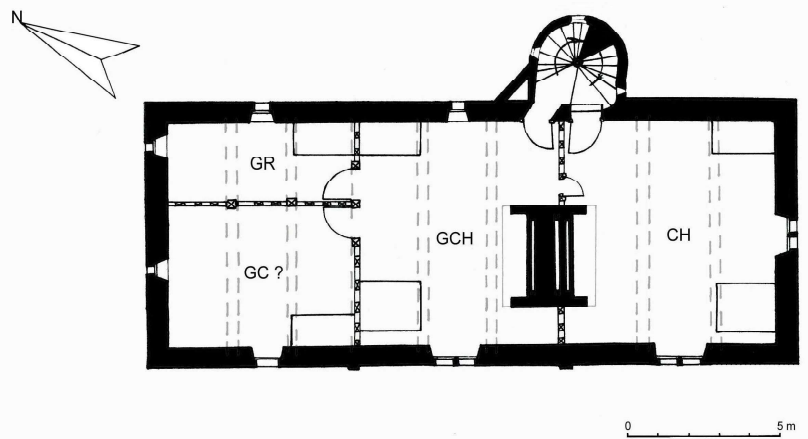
Mentheville. Plan restitué du premier étage entre 1595 et 1606.
